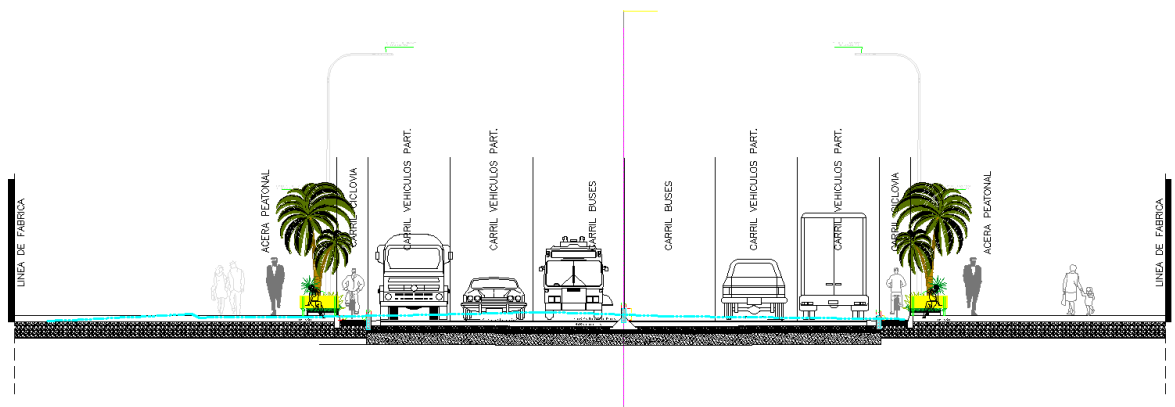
Sección típica Avenida. Quito 0+000 - 0+637.2
